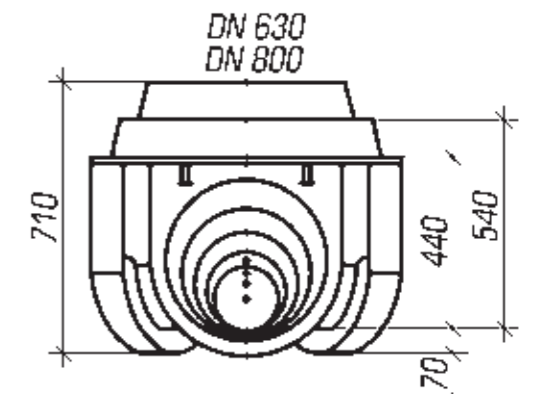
Чертеж устройства лотка 630–800 мм (вид сбоку)
